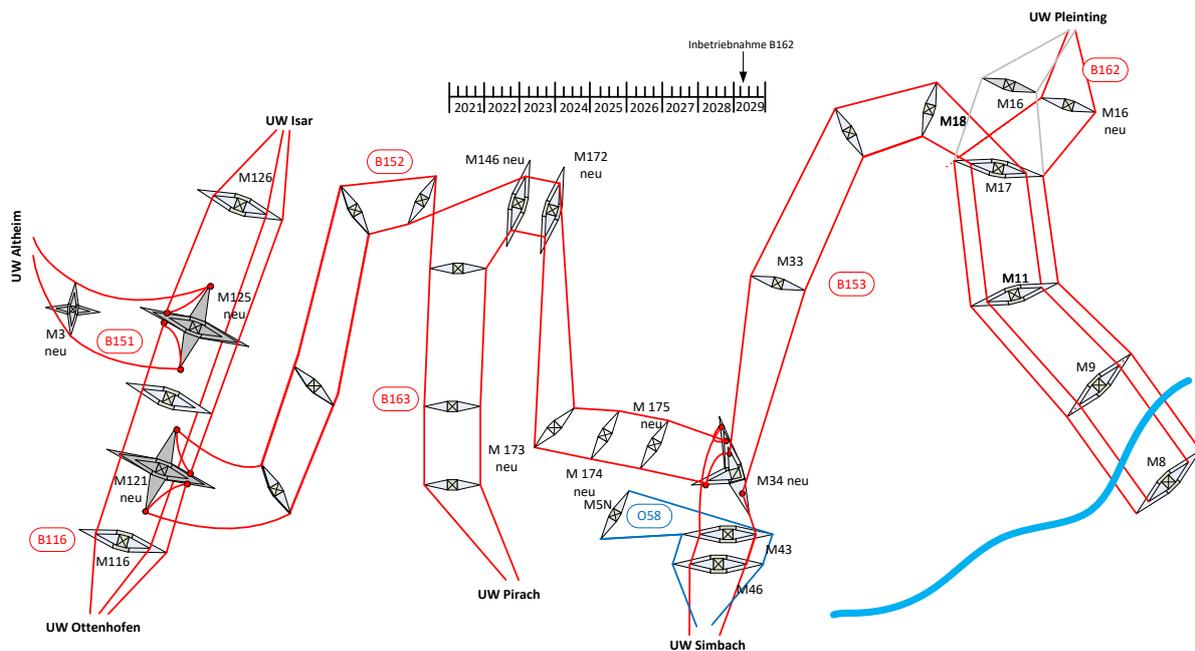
Spannungsumstellung B163 und Errichtung Pleinting – Prienbach B162
